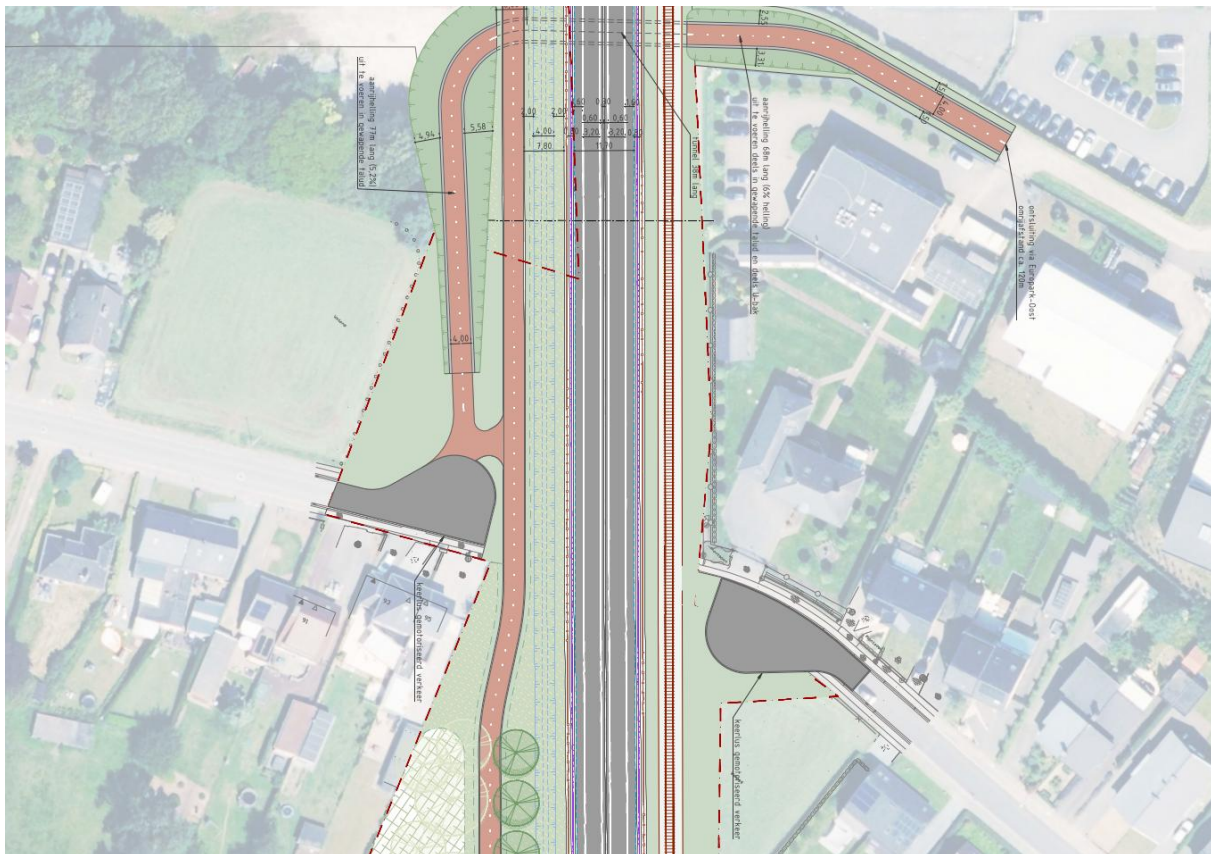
Fietstunnel Damstraat (optie rechte tunnel)
